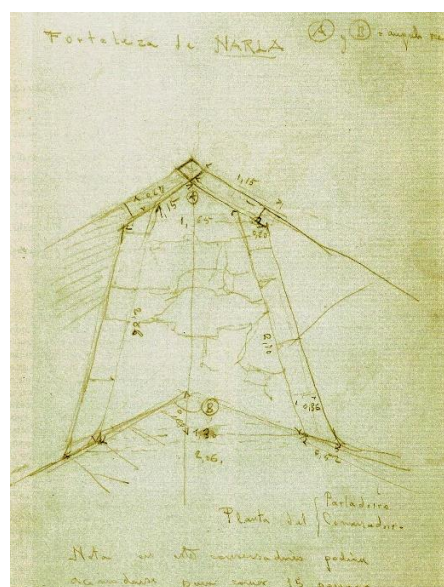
Detalle en planta de la ventana parladoiro en esquina existente en las fachadas norte y este del cuerpo posterior. Ídem, p. 315.
